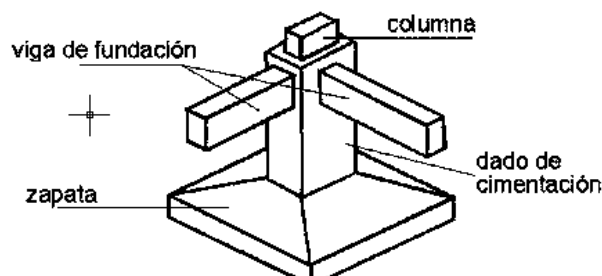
zapata aislada elaborado por ETM, con el programa AutoCAD
